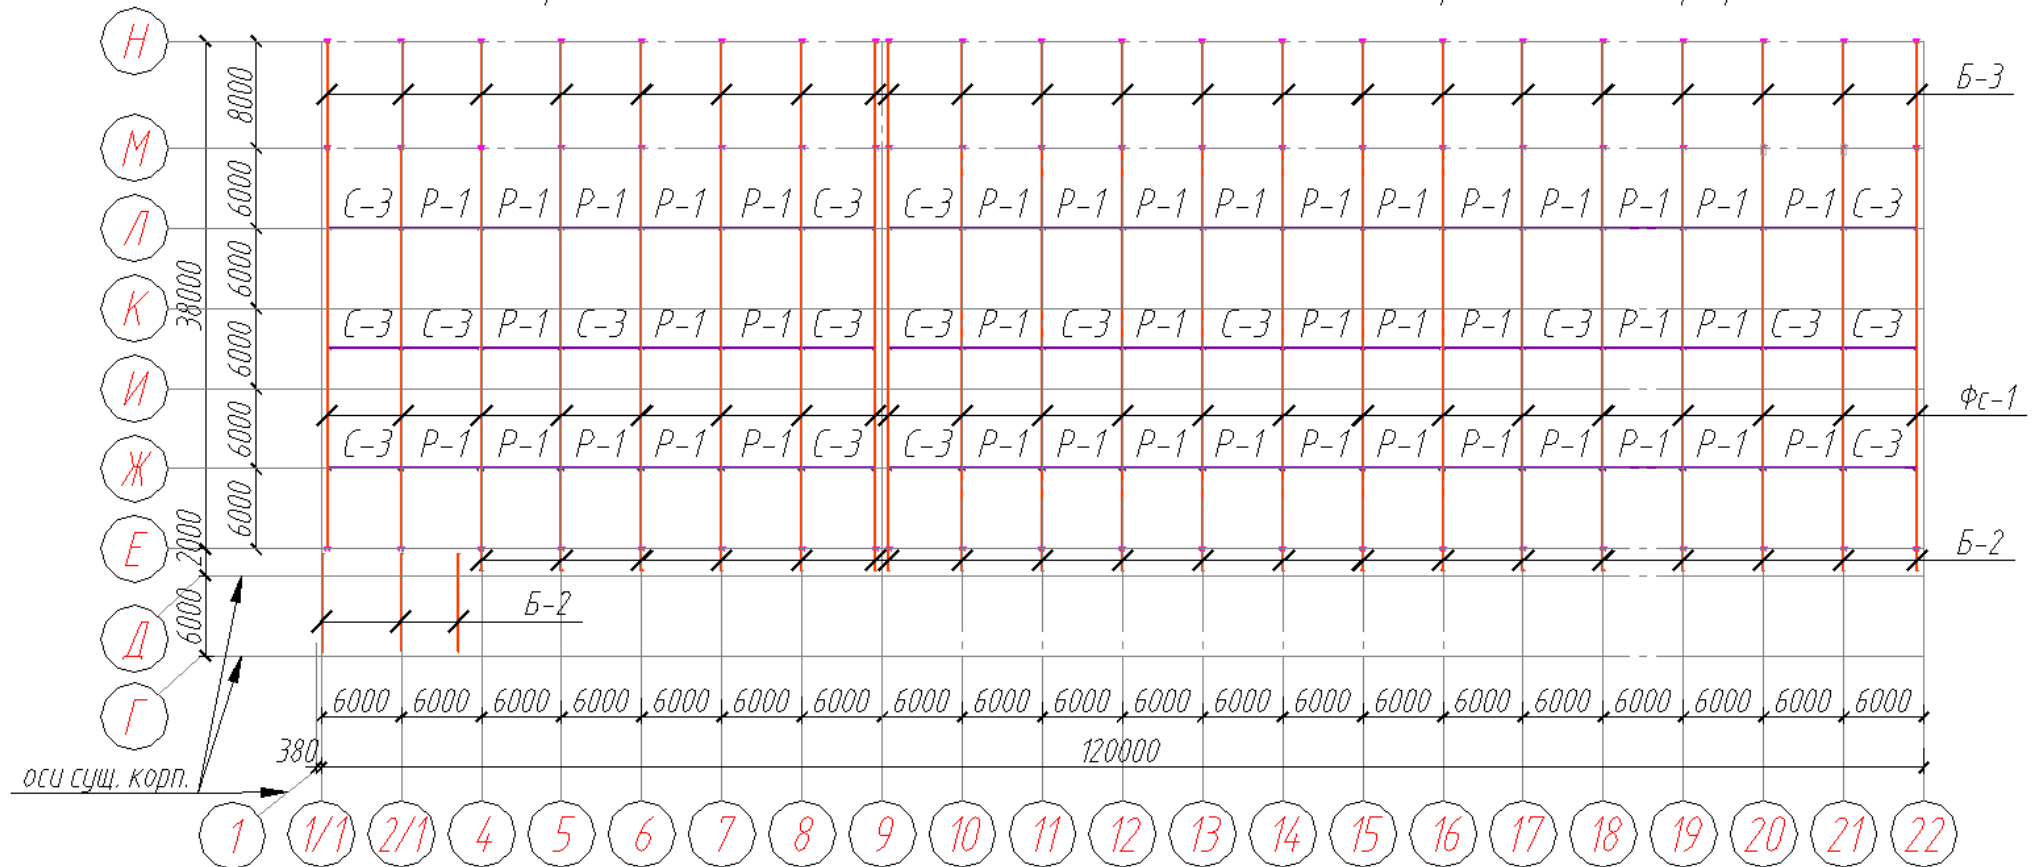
Схема расположения связей по верхним поясам стропильных ферм
